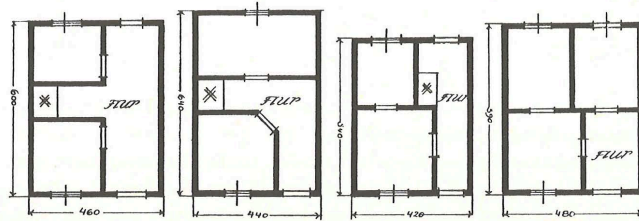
Grundrisse der vier häufigsten Bremischen Ganghaustypen seit dem späten 16. Jhdt.
